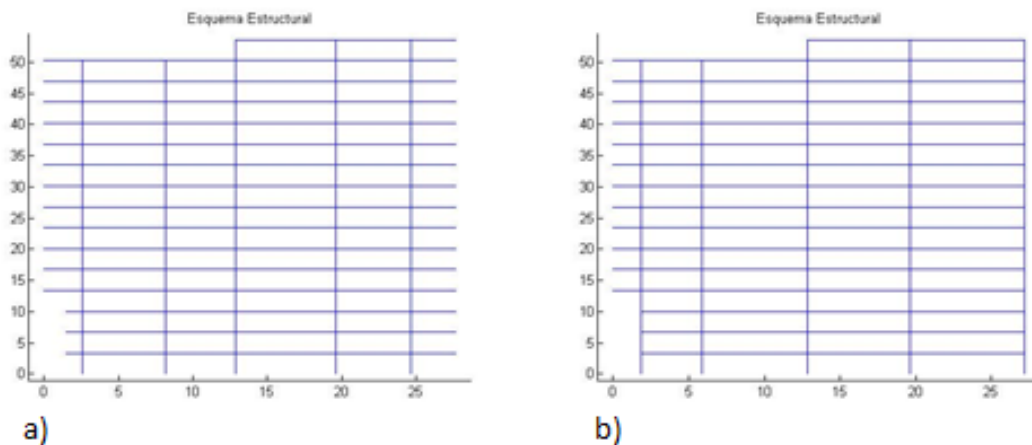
Pórticos transversales sin reforzamiento a) Pórtico 1; b) Pórtico 3.
